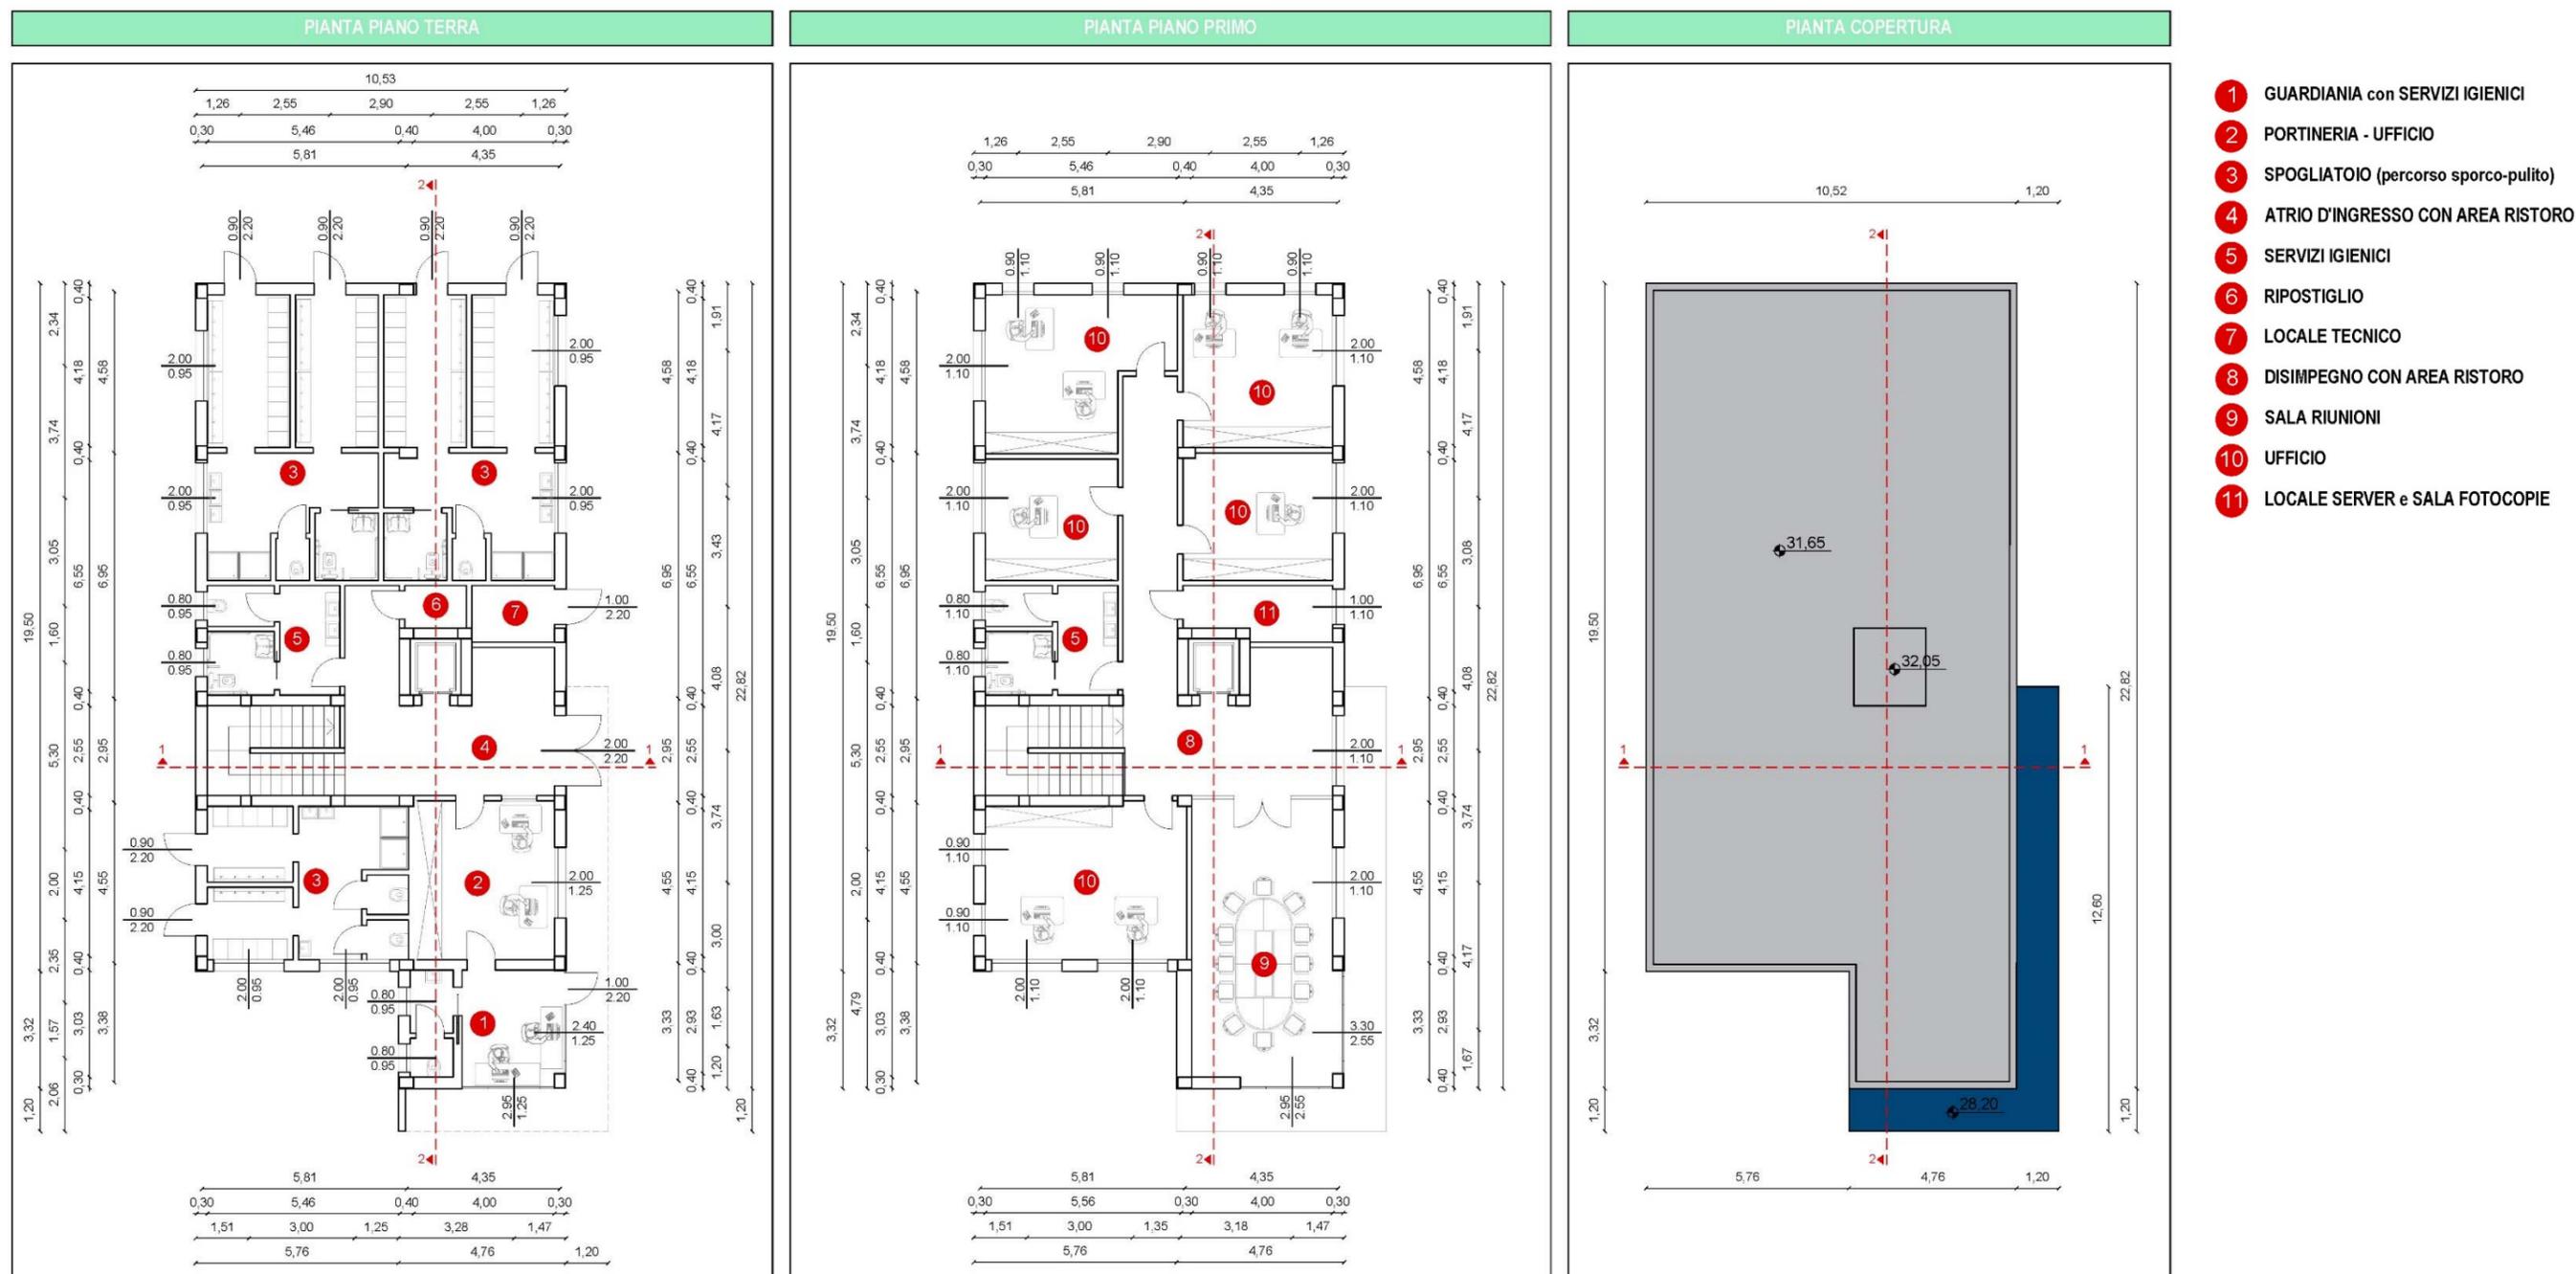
Pianta piano terra e piano primo della nuova palazzina uffici e spogliatoi
